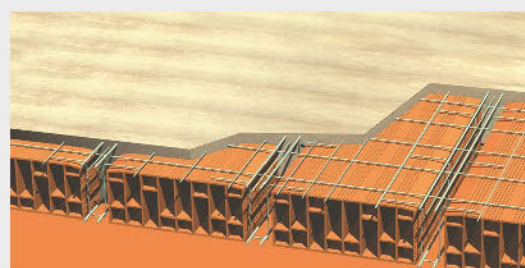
Forjado unidireccional con nervios hormigonados "in situ"
